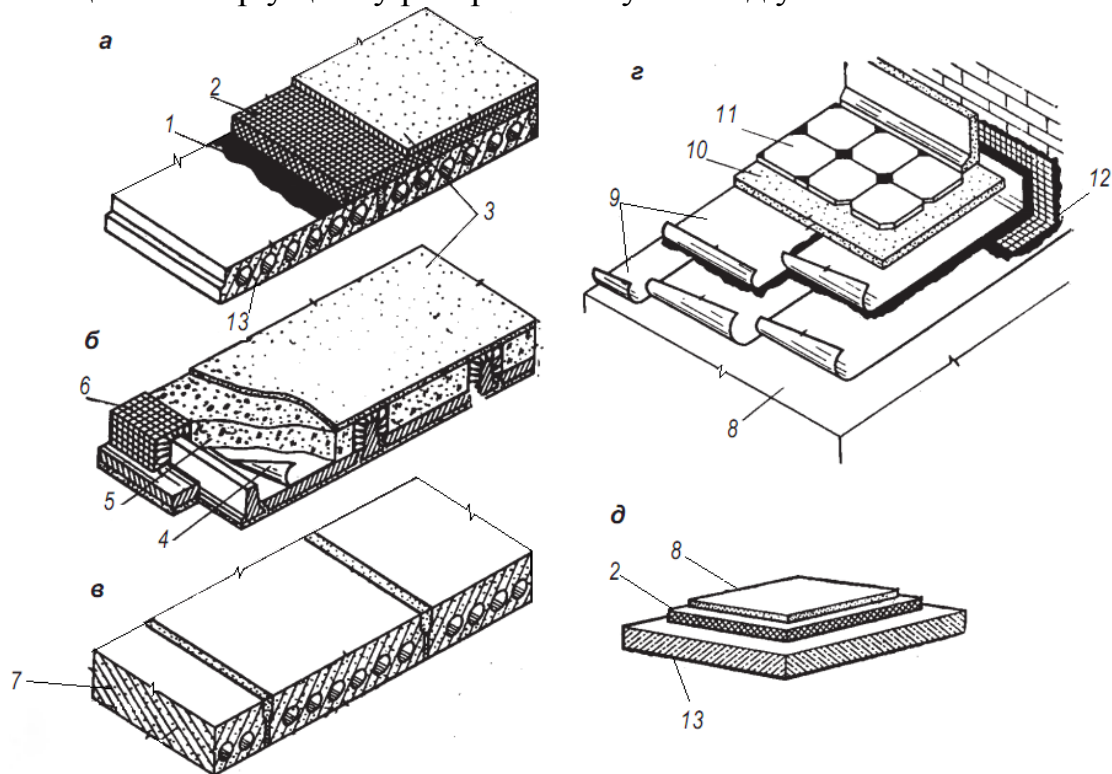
Переkritтя: а – горищне переkritтя по залізобетонним панелям, утепленим плитним матеріалом; б – теж по залізобетонним балкам, утепленим сипучими матеріалами; в – теж із утеплених панелей; г – переkritтя в санітарних вузлах; д – надпідвальне переkritтя; 1 – бітумна обмазка; 2 – плитний утеплювач; 3 – стяжка вапняна; 4 – пароізоляція; 5 – сипучий утеплювач; 6 – утеплювання балки; 7 – горищні панелі із легкого бетону завтовшки 280 мм; 8 – вирівнююча стяжка із розчину; 9 – рулонна гідроізоляція; 10 – вирівнююча стяжка під підлогу; 11 – керамічна плитка; 12 – полоса із гідроізоляційного матеріалу завтовшки 150...200 мм; 13 – несуча залізобетонна панель
